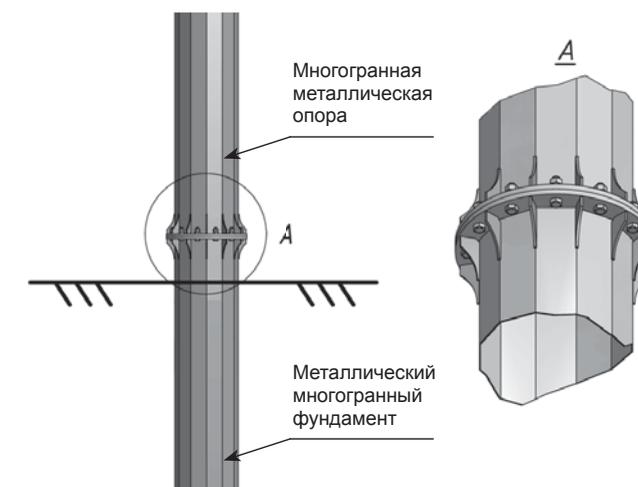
Схема фундамента из сваи-оболочки многогранного сечения
